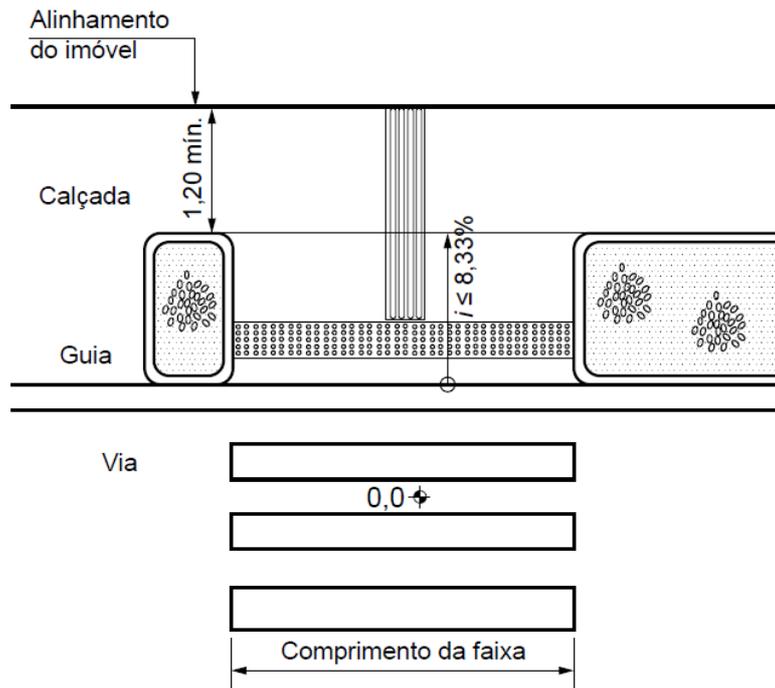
Rebaixamentos de calçada entre canteiros – Vista superior
